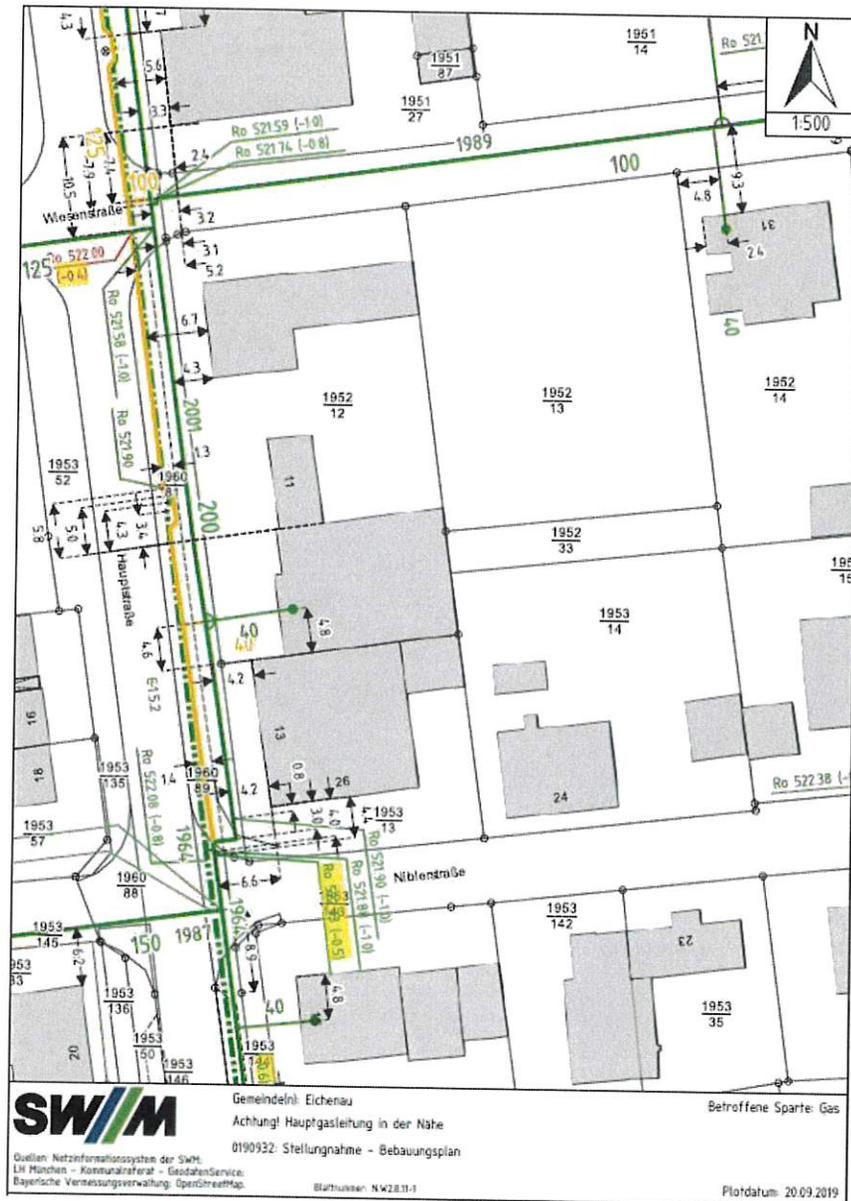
Bestandsplan Erdgasversorgungsanlagen, ohne Maßstab, Quelle: SWM
